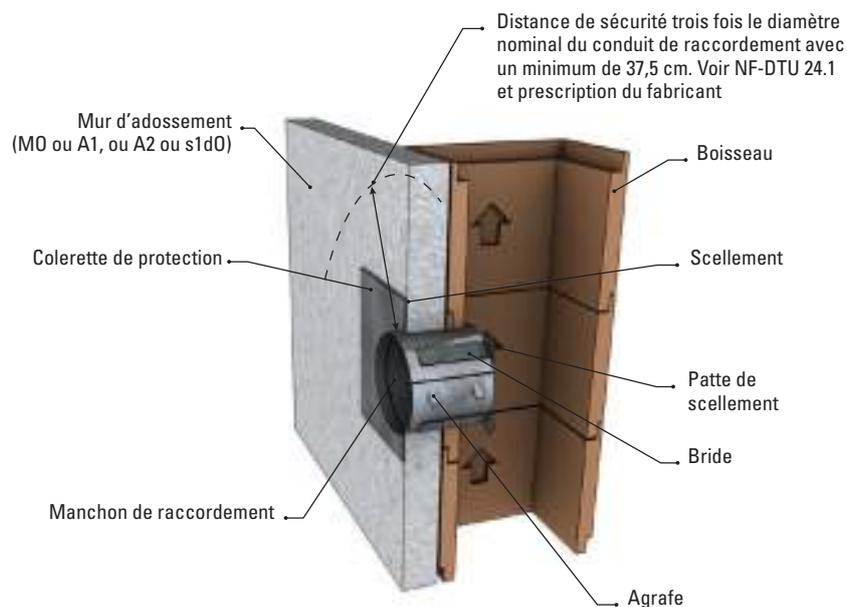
Exemple de scellement d'un manchon à un conduit de fumée maçonné (avec traversée de paroi)
